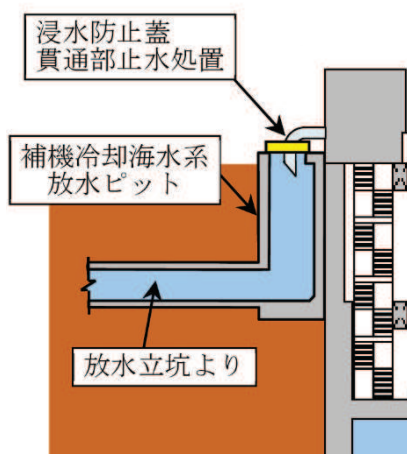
3号機 放水立坑 浸水対策配置図 (A-A 断面図)
